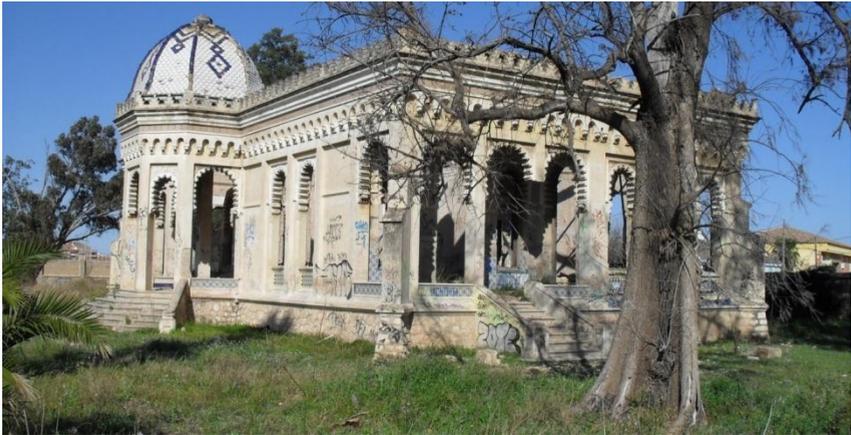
Alzado Oeste y Alzado Sur (2014) - Fuente propia
